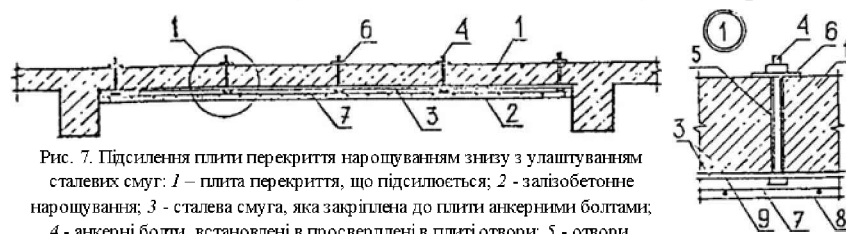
Підсилення плити перекриття нарощуванням знизу з улаштуванням сталевих смуг: 1 – плита перекриття, що підсилюється; 2 – залізобетонне нарощування; 3 – сталеві смуги, яка закріплена до плити анкерними болтами; 4 – анкерні болти, встановлені в просвердлені в плиті отвори; 5 – отвори, просвердлені в плиті; 6 – шайби; 7 – арматурна сітка, приварена до сталевих смуг; 8 – бетон нарощування, що наноситься методом торкретування; 9 – поверхня плити, що підсилюється, підготовлена до бетонування
